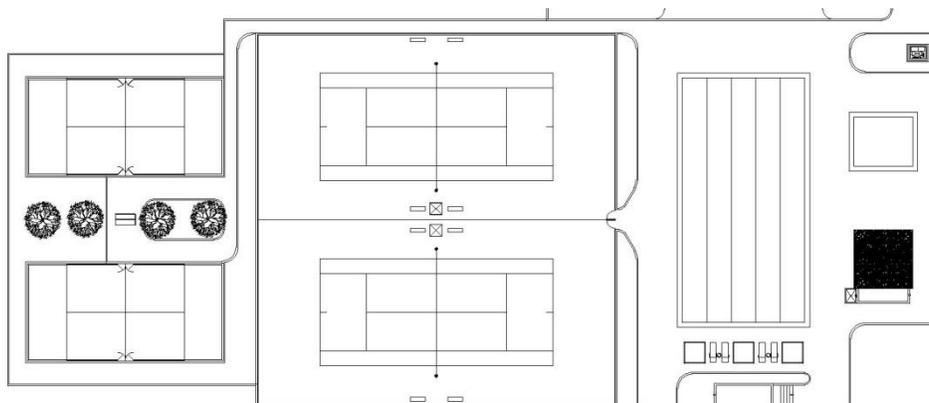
32. Planta Arquitectónica de Azotea tipo de la Casa Club Palapa.
